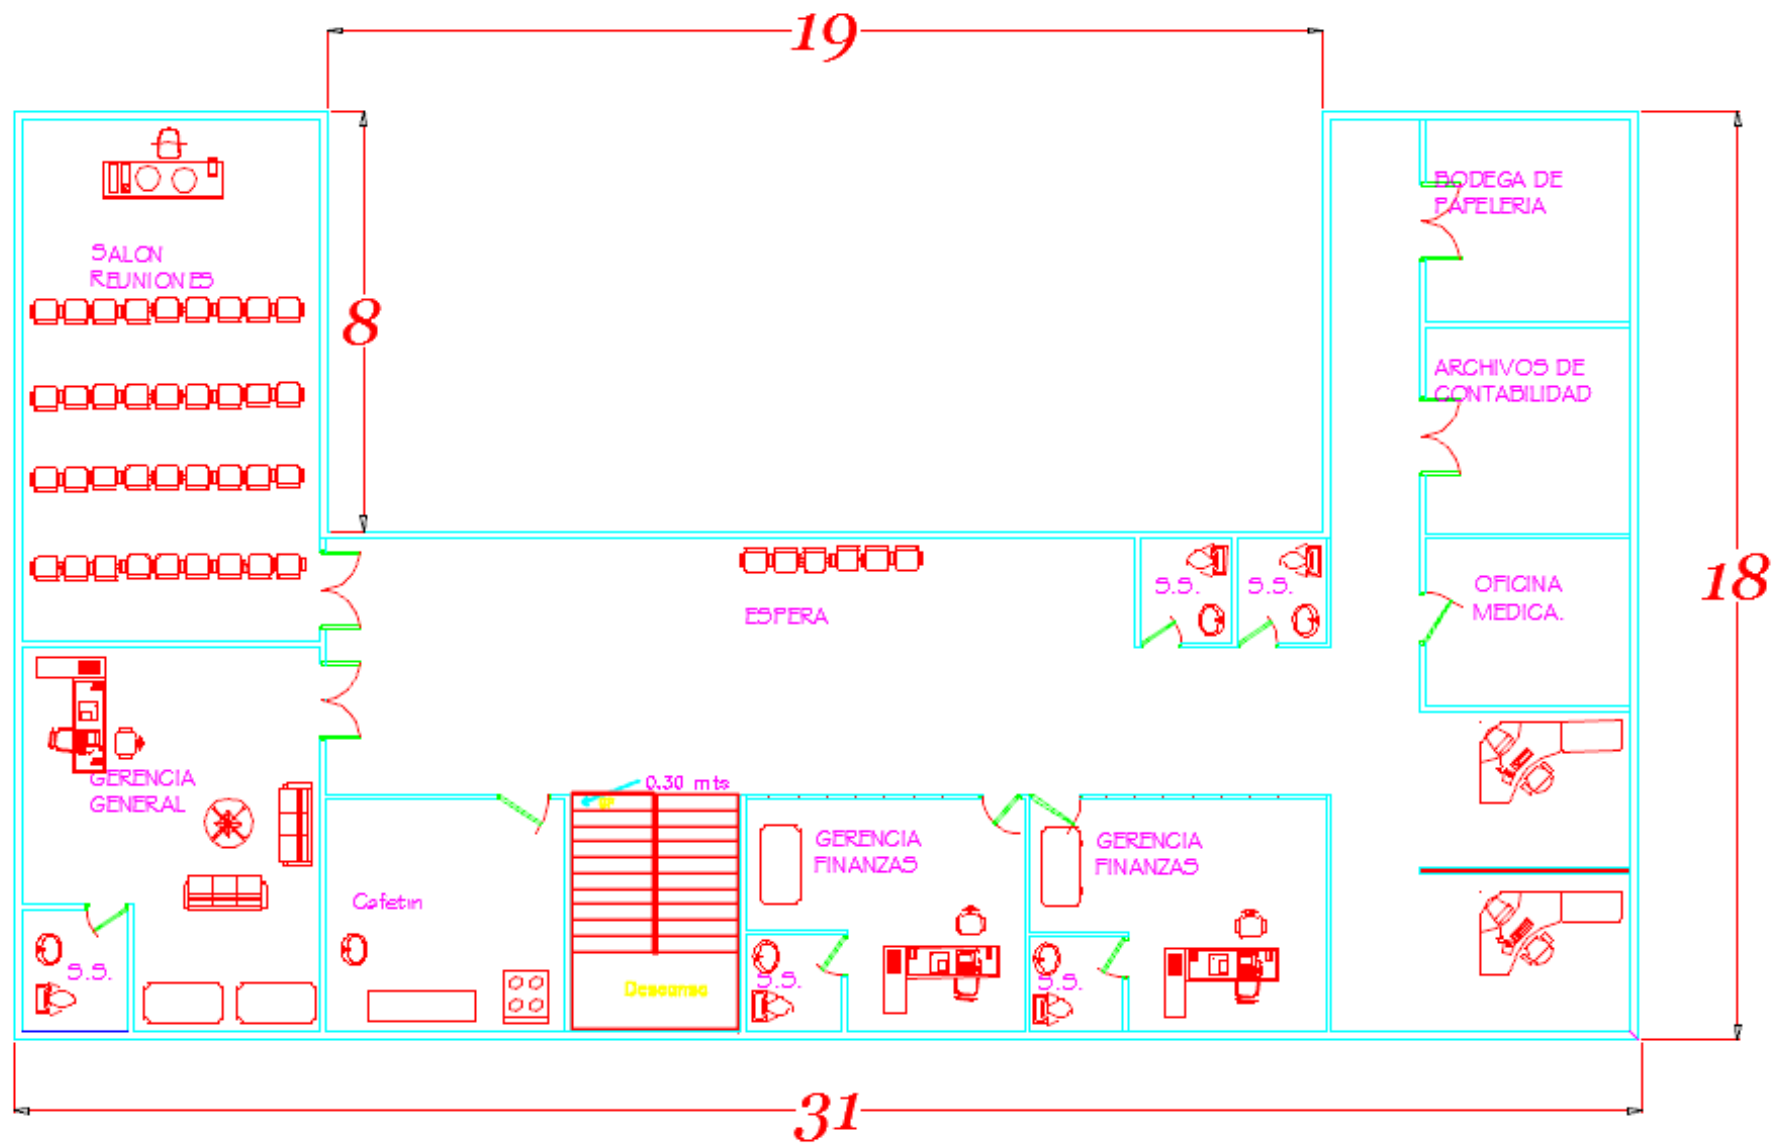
Vista en planta general del segundo nivel, acotada y sin escala.
